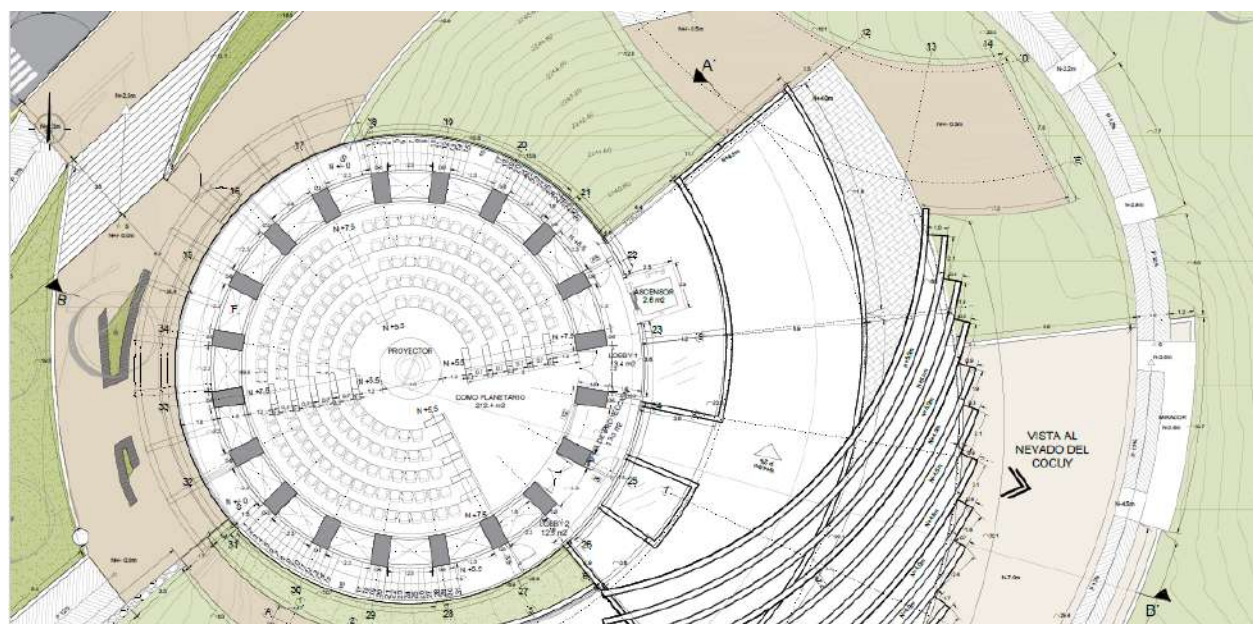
Planta ubicación general nivel +/- 0.0m edificio Sur
